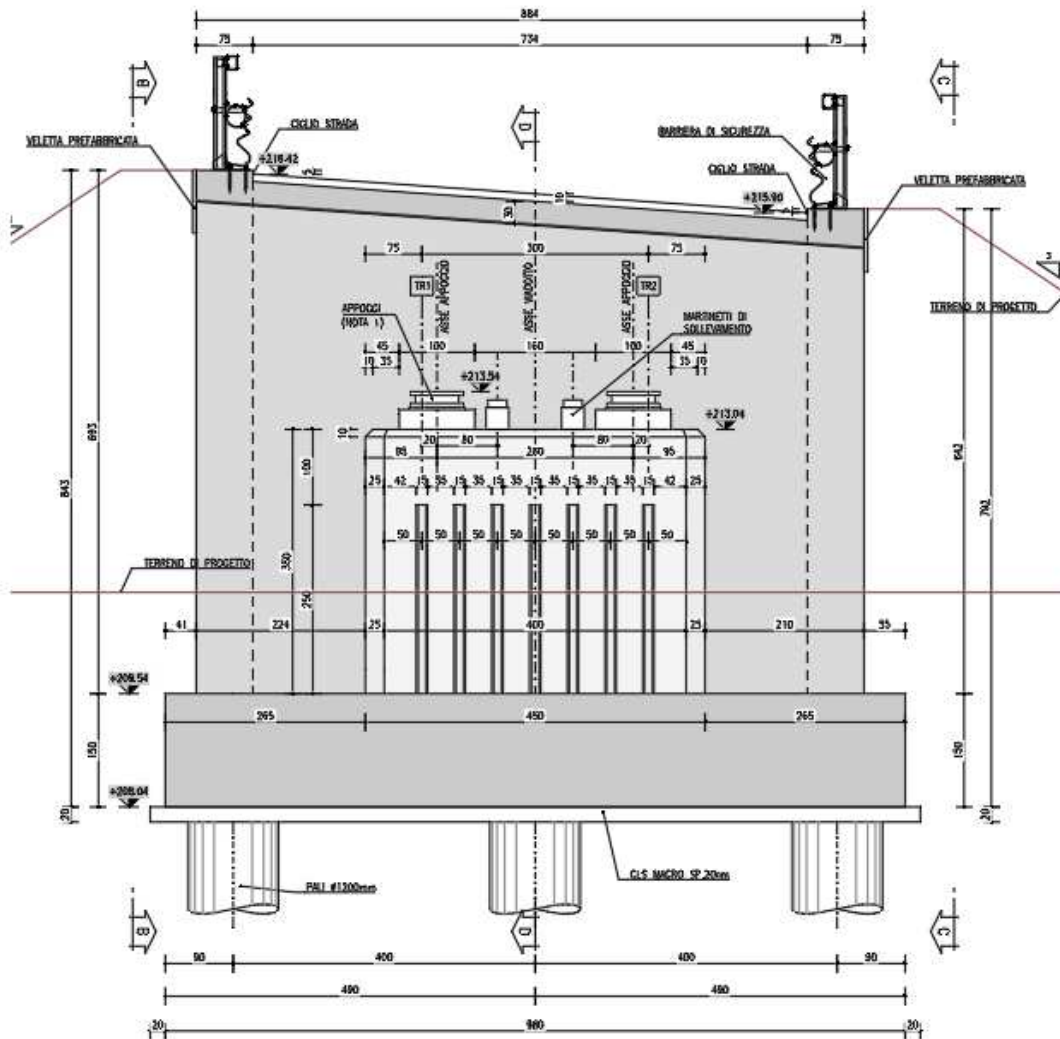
Spalla 1 – carpenteria elevazioni
